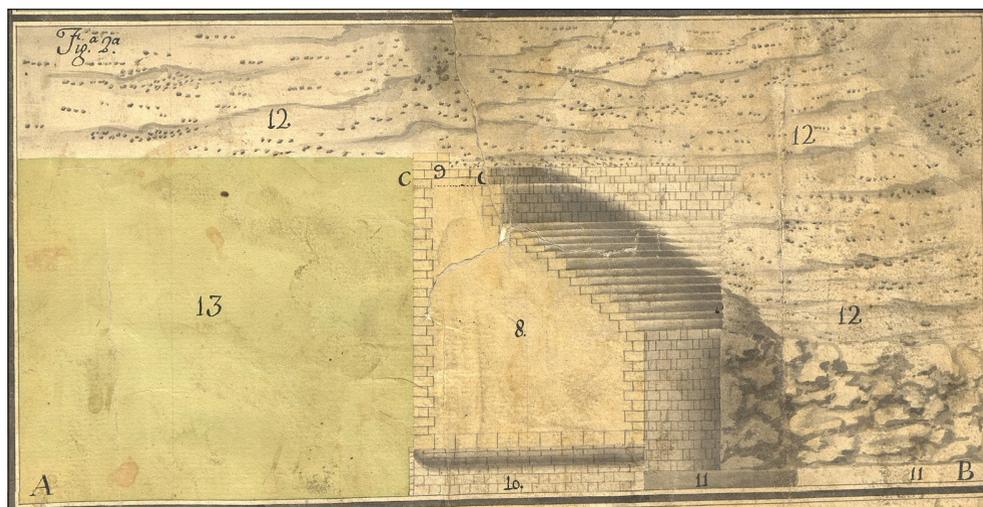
Sección del pantano con el estado previo a la construcción del recrecimiento (sección 8 del plano)
